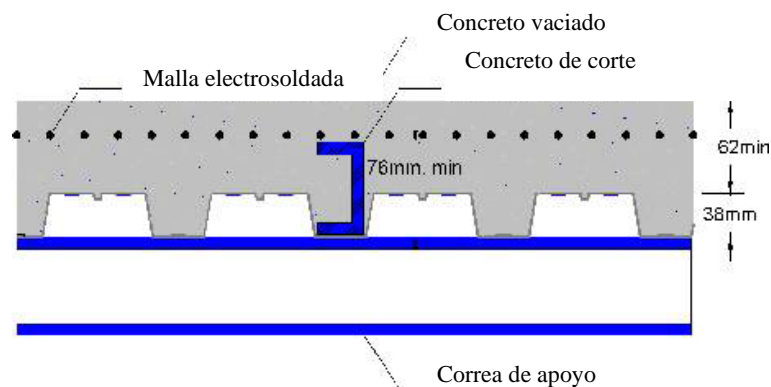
Detalle de Losa compuesta de láminas galvanizadas de Losacero Centrolit®. Fuente: http://www.centrolit.com.ve/Articulos.php?articulo_no=177& (2013)
